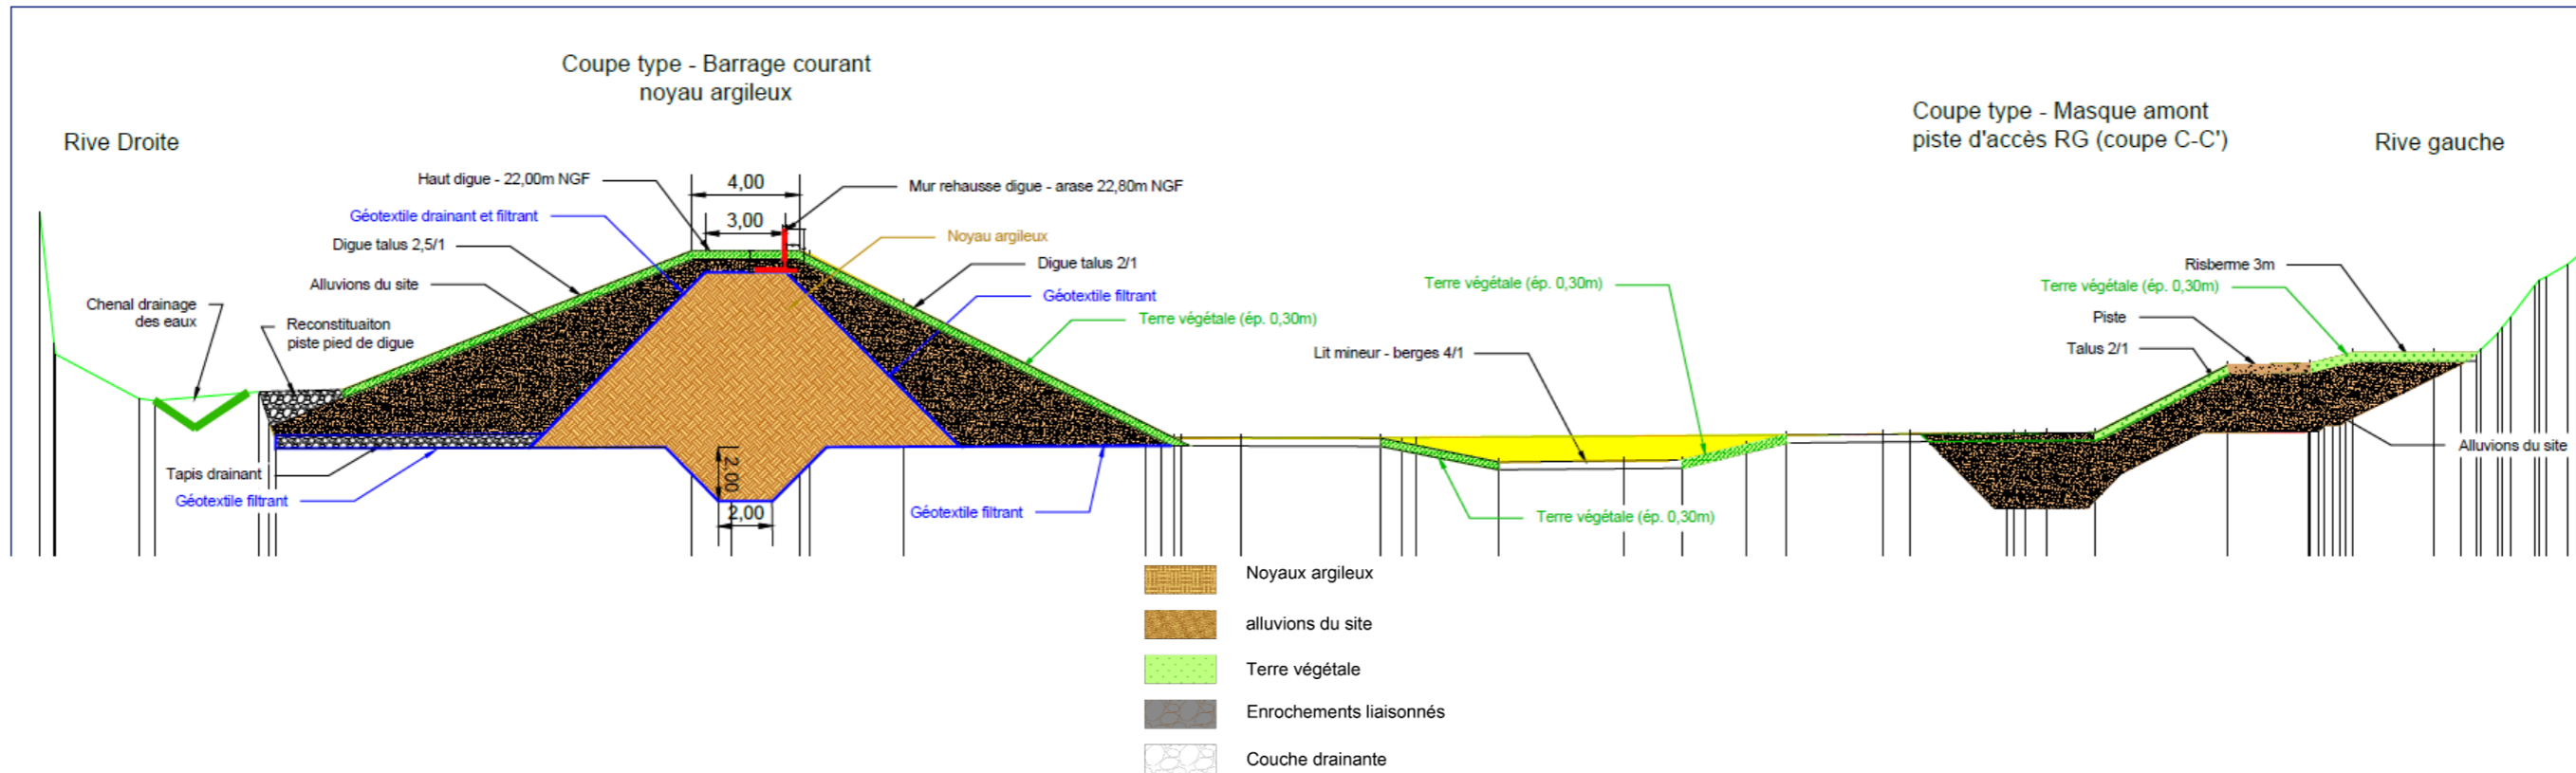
Coupe C-C' de la section courante – plan AVP
